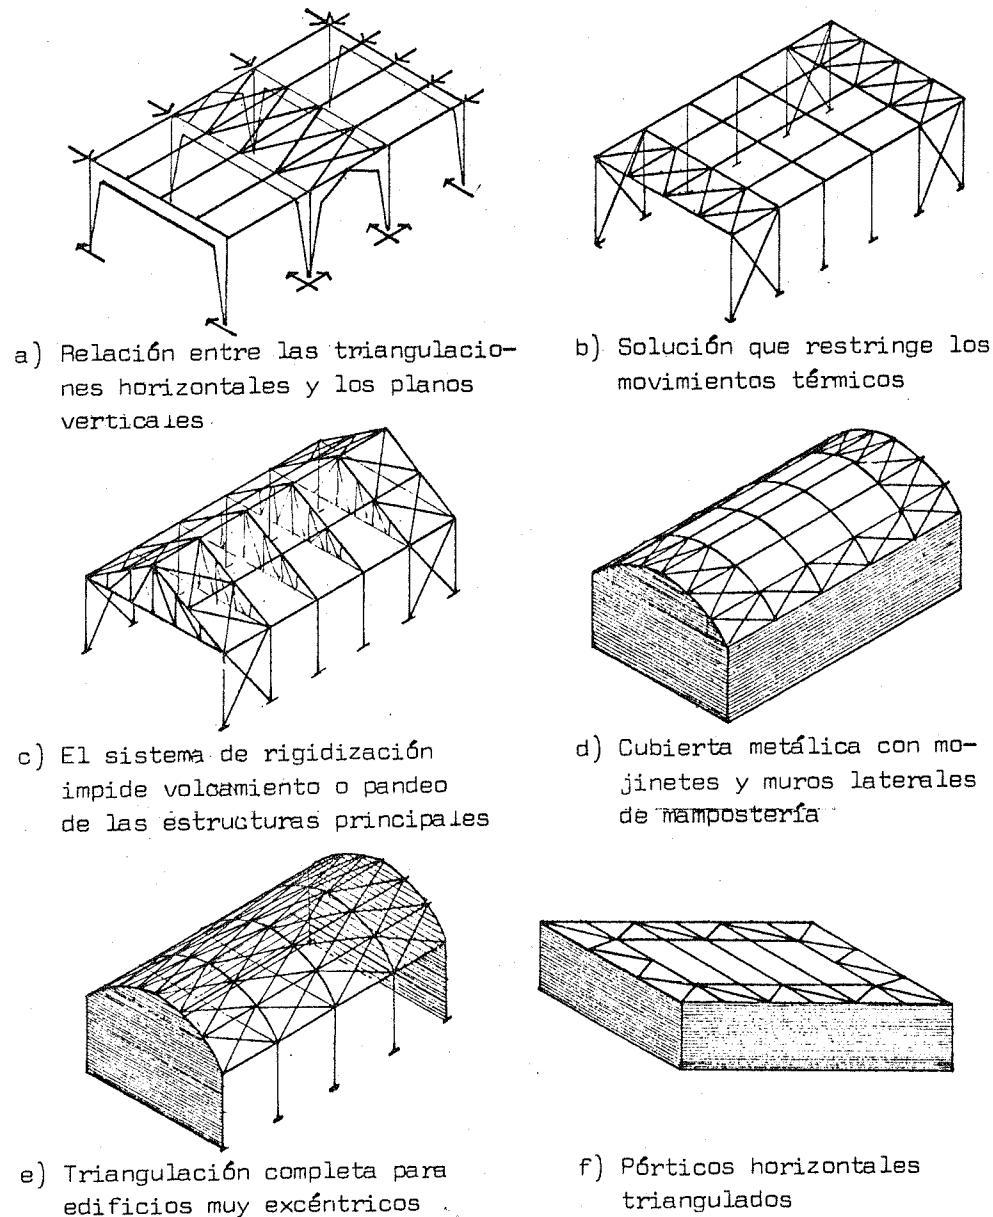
Triangulaciones de rigidización en el plano horizontal
